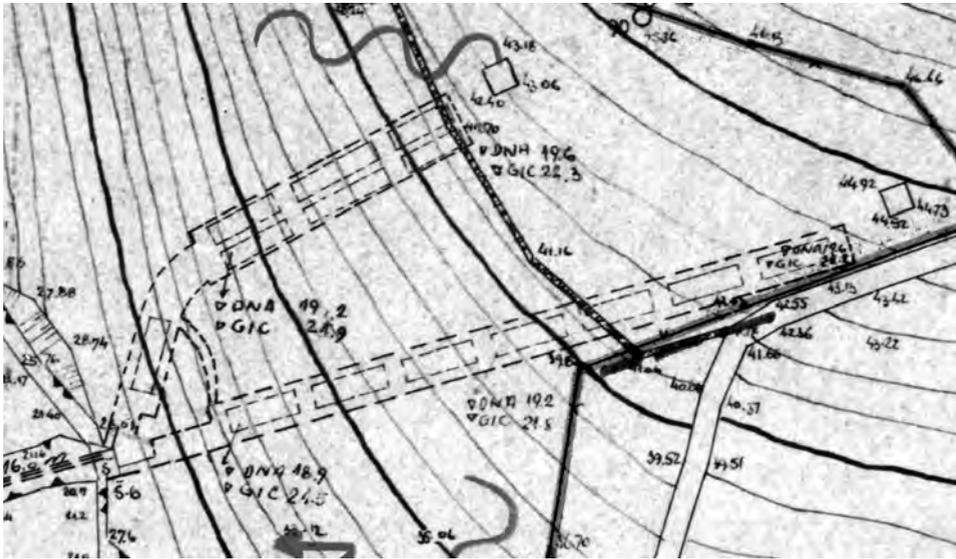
Pianta dei due tunnel (senza l'accesso a sinistra).
